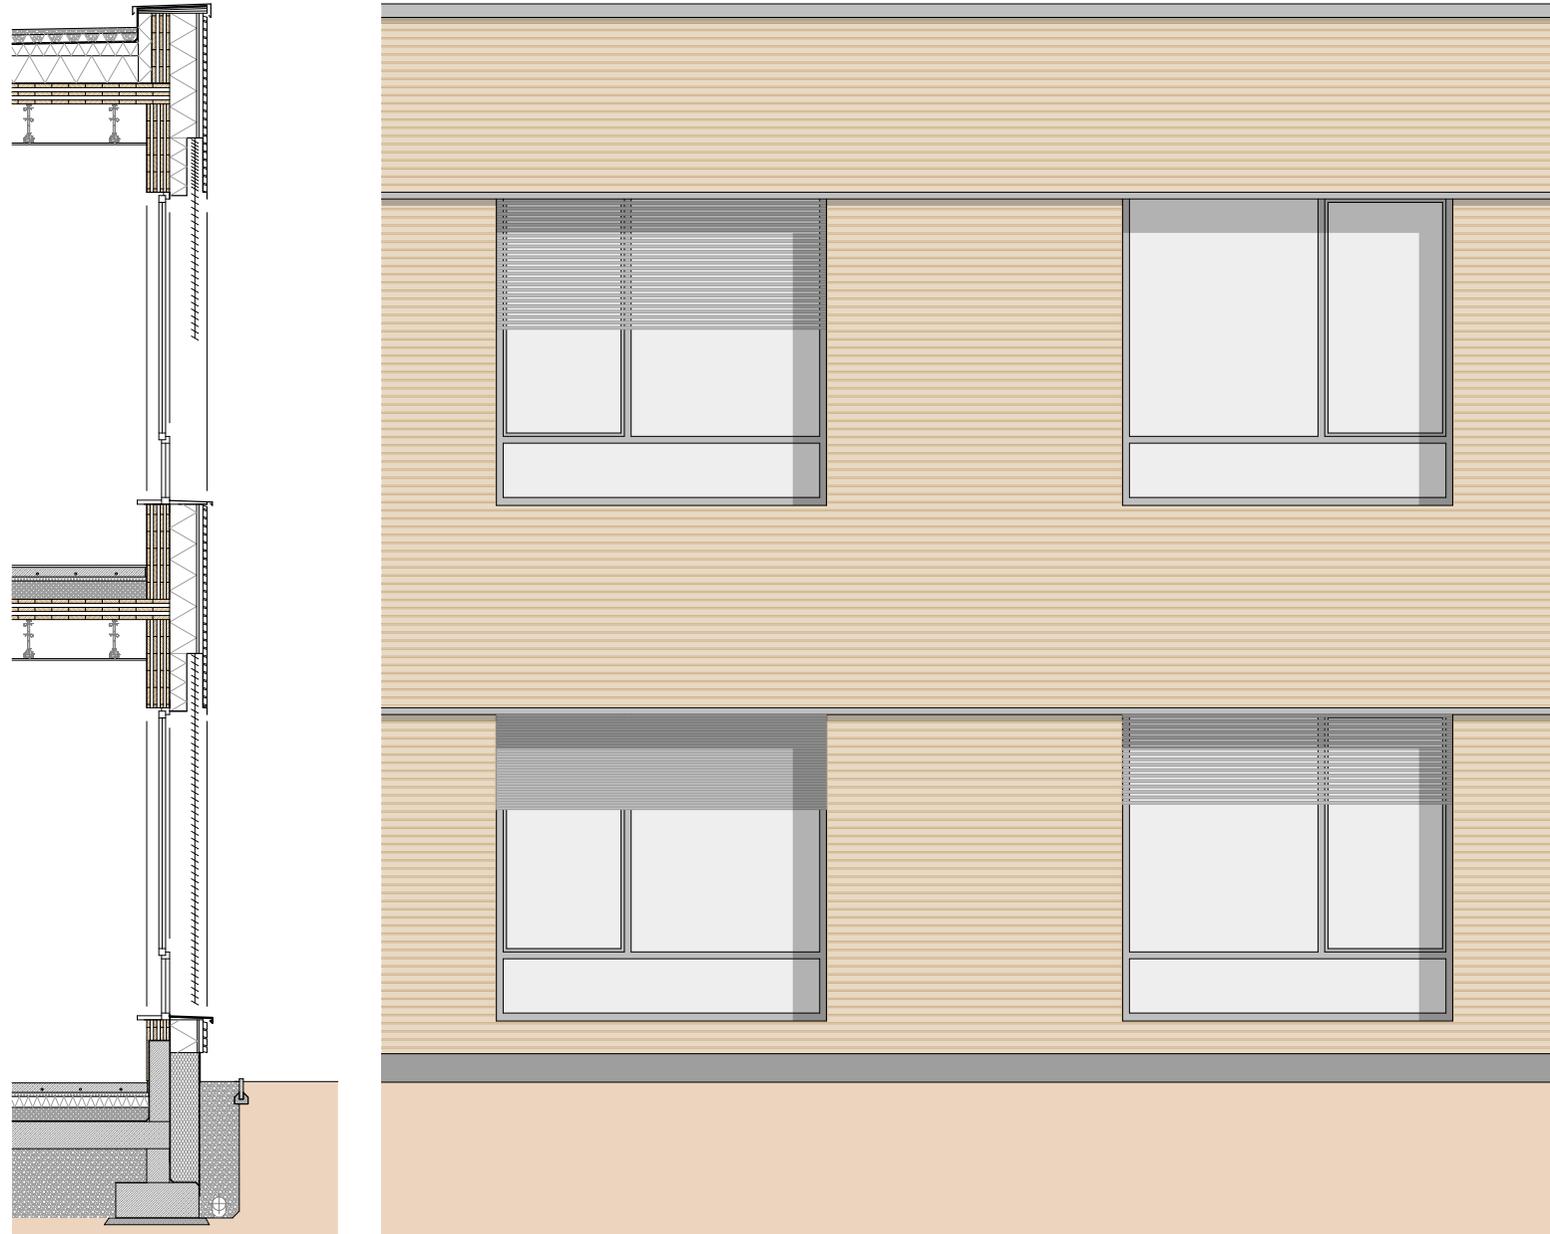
Fassadenschnitt / Fassadenansicht
